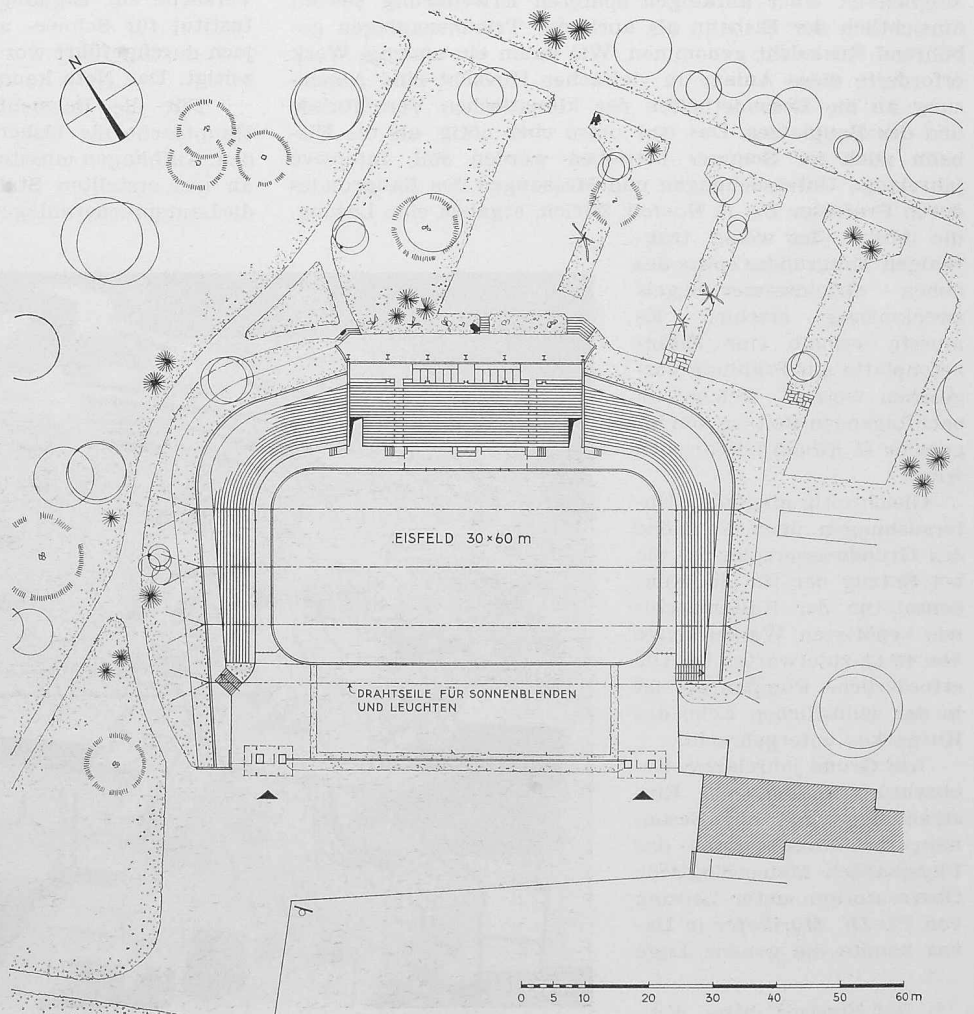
Lageplan der neuen Eisbahn, Masstab 1:1200
